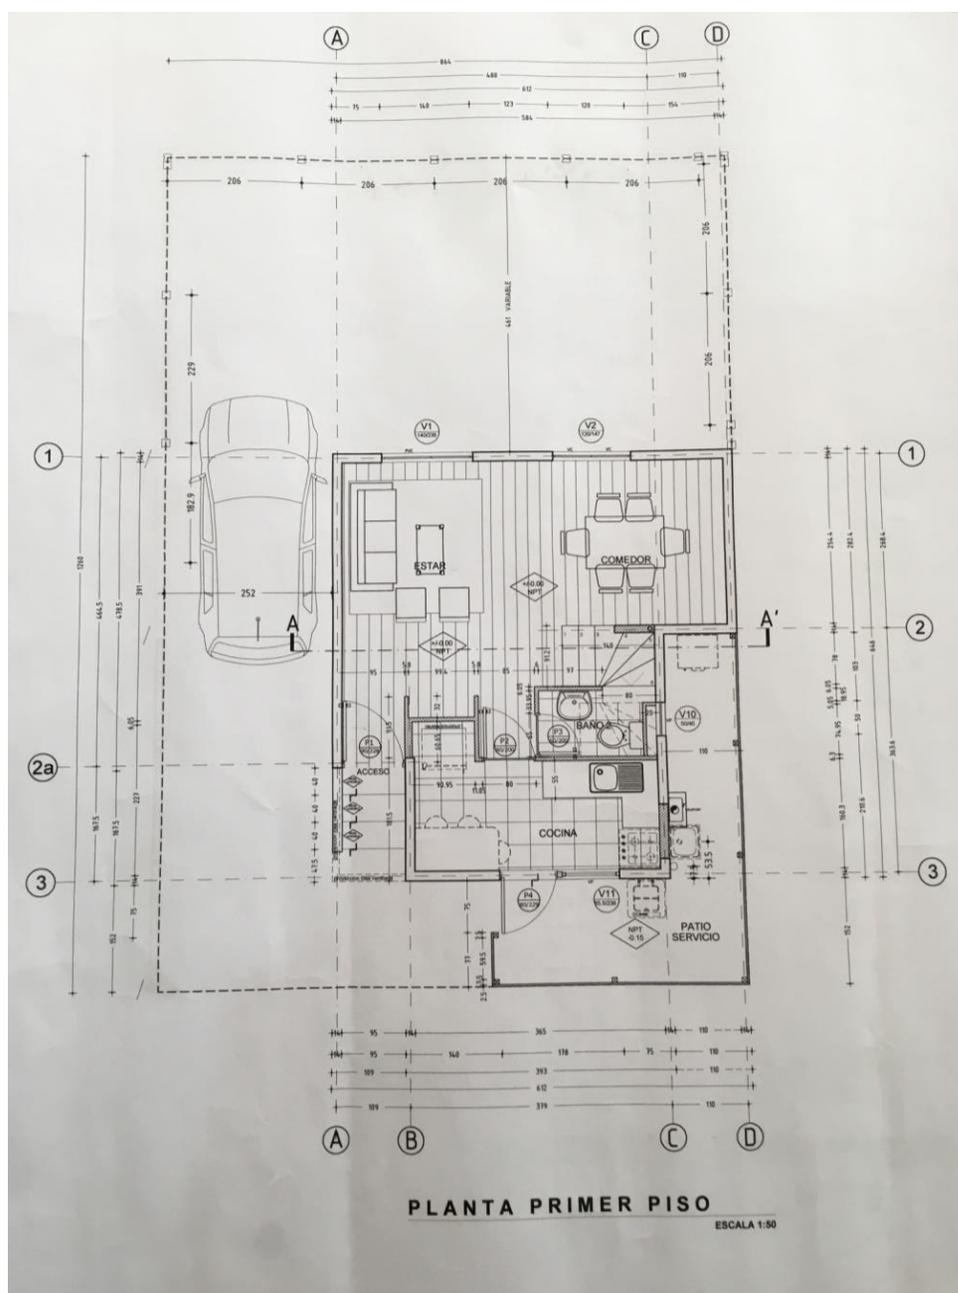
Planta primer piso casa tipo B1 aislada.
